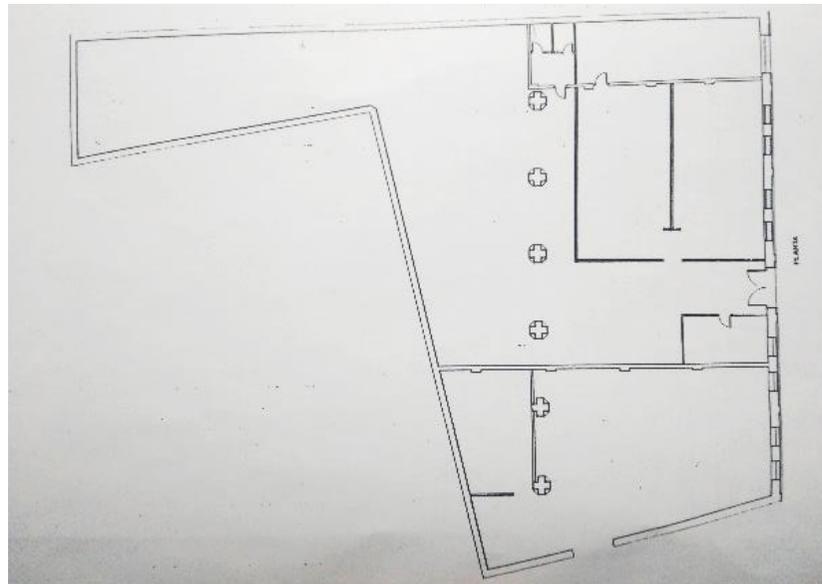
y 24. Planos de arquitectura, sección transversal y alzado exterior según levantamiento en 1985. Probablemente conserva parte de su distribución original. Fuente: GMU
